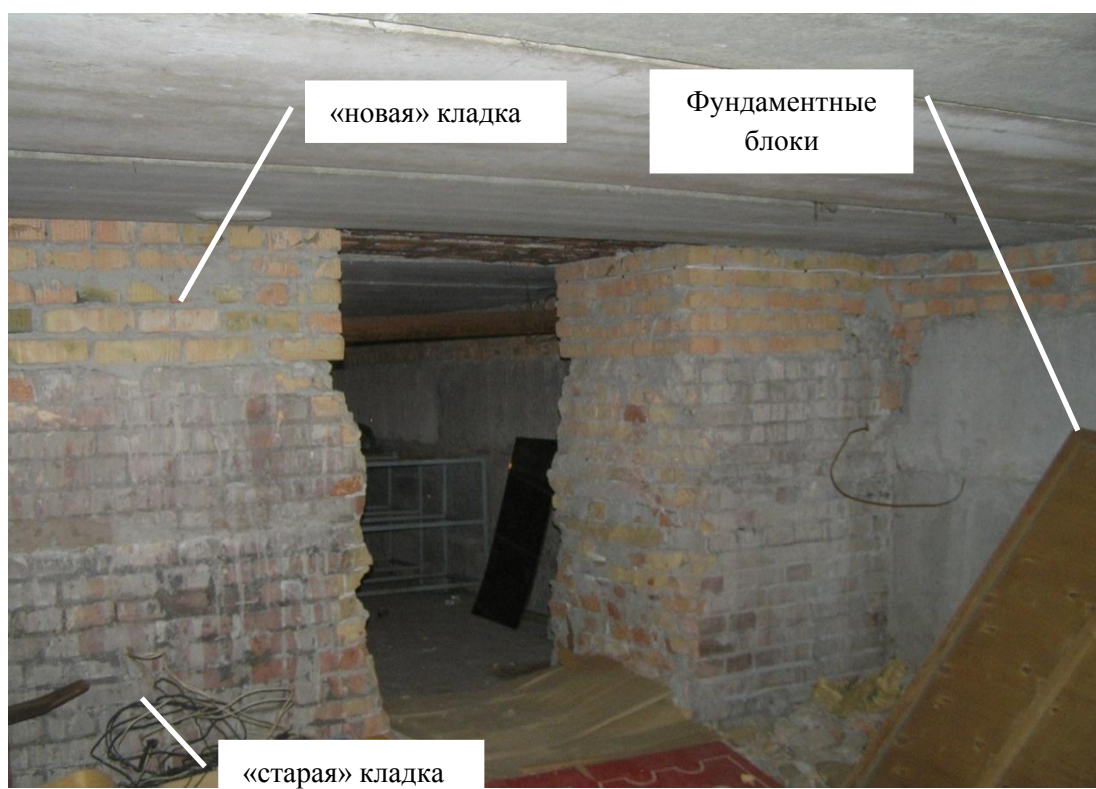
Общий вид средней поперечной стены подвала и плит перекрытия
